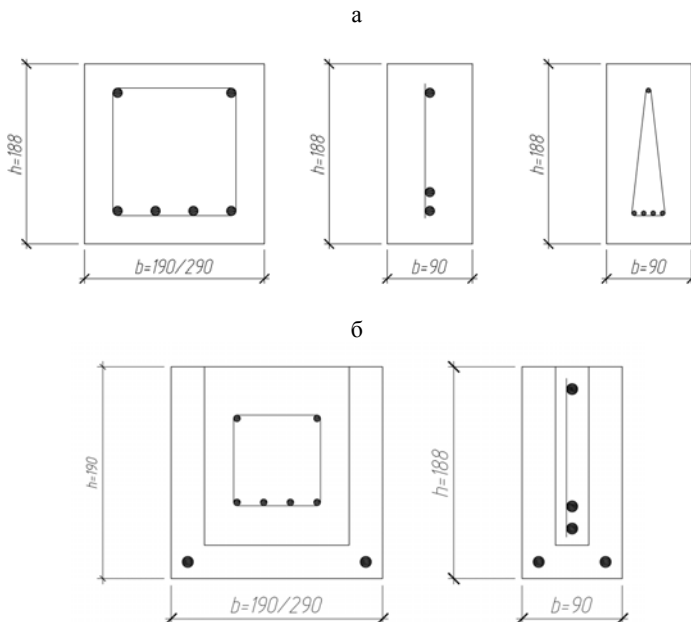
Предлагаемые к дальнейшему исследованию перемычки из керамзитобетона с композитной арматурой: а – сплошного, б – комплексного сечения
